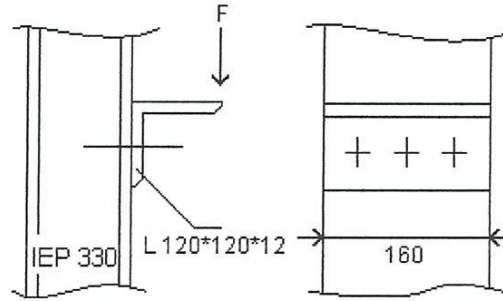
Assemblage d'une cornière en console sur un poteau.
